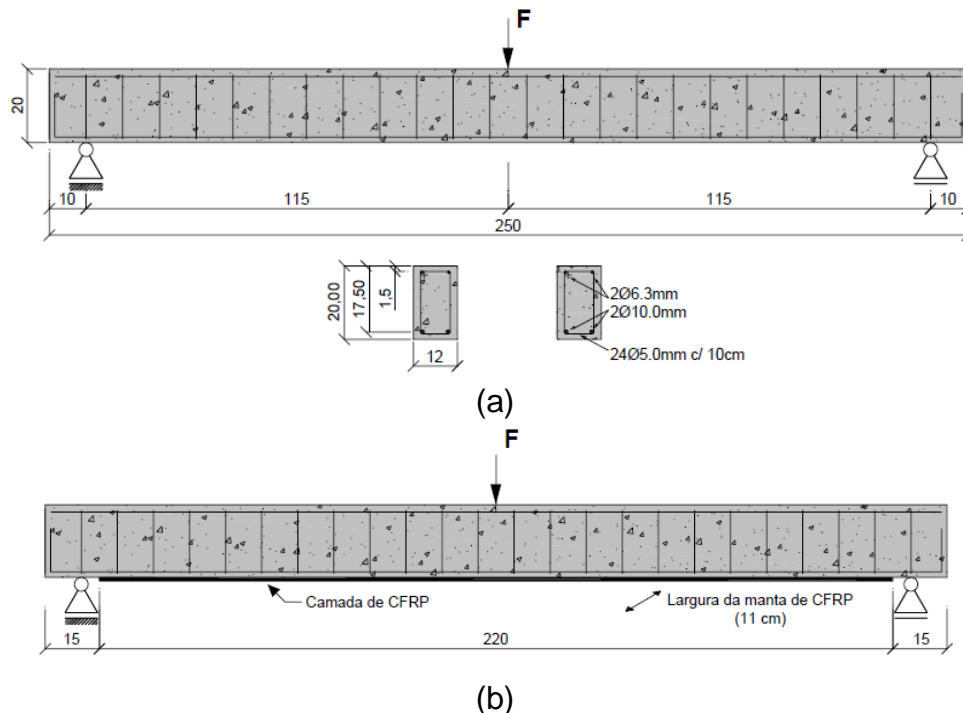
Dimensões, detalhamento das armaduras e condições do ensaio à flexão: (a) vigas V_REF_0, (b) vigas V_REF_CFRP (medidas em cm) (FERREIRA (2019)).
